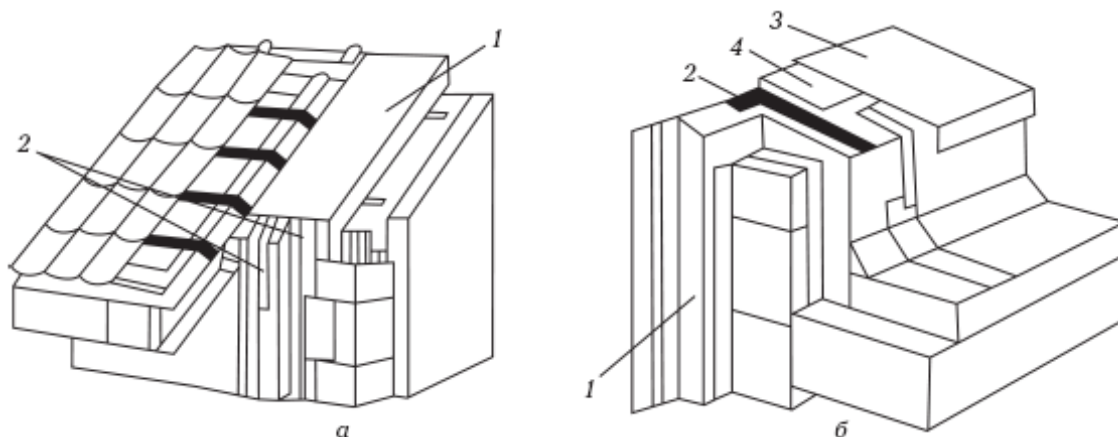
Соединение с утеплителем стены утеплителя: а) скатной крыши; б) плоской крыши; 1 – утеплитель; 2 – армирующая сетка; 3 – жестяной фартук; 4 – уплотняющая лента из полиуретана
